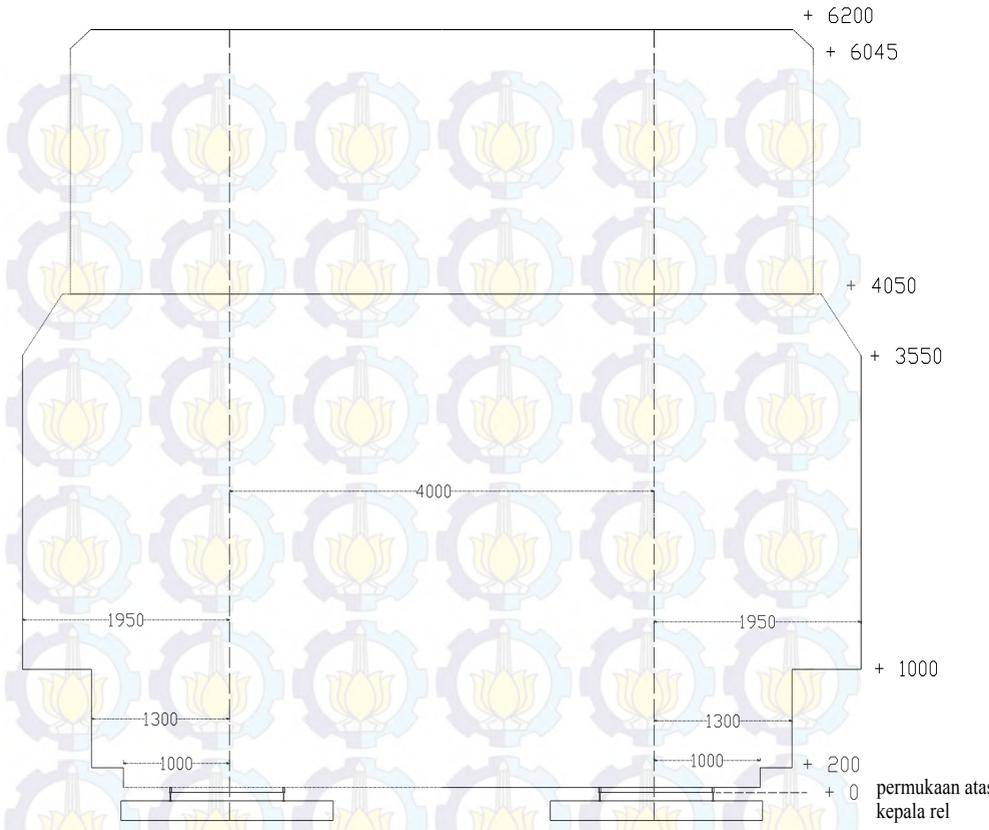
Ruang Bebas Pada Lengkungan
